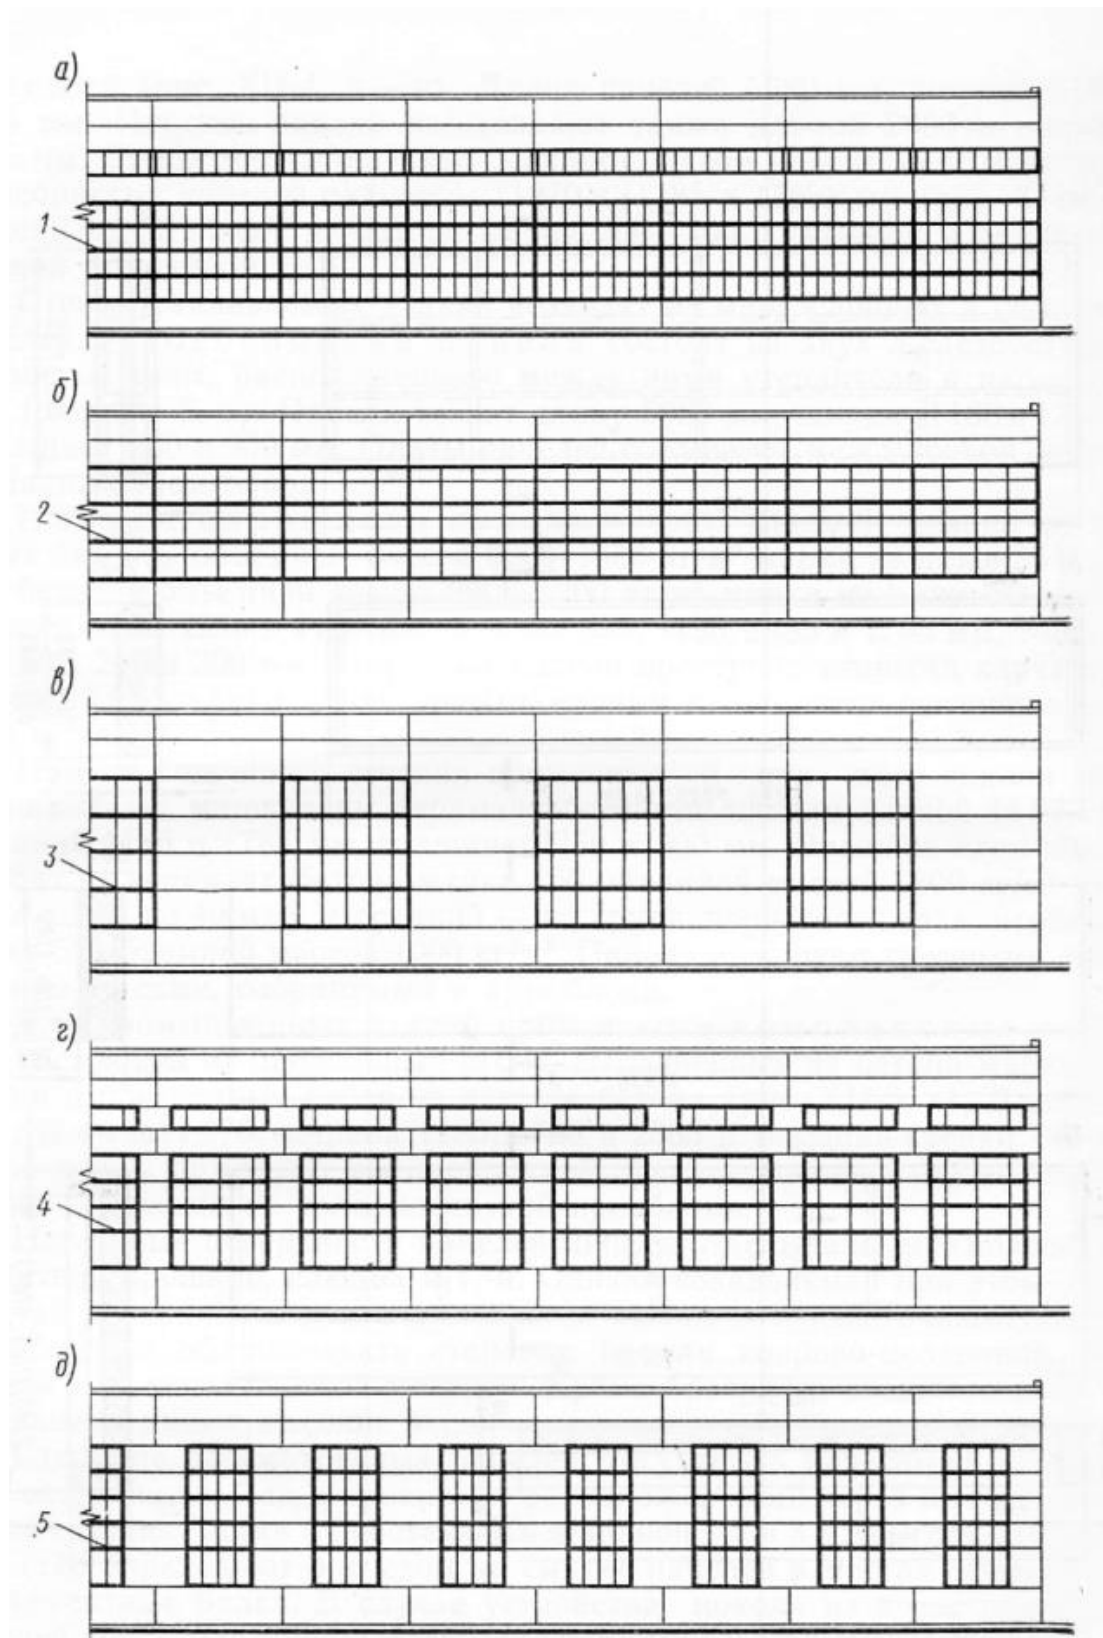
Варианты разрезки стен одноэтажных зданий:
